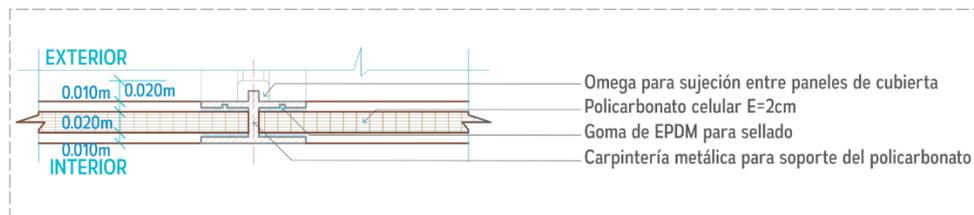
, Detalle en sujeción entre paneles de cubierta, fuente: Autor.
